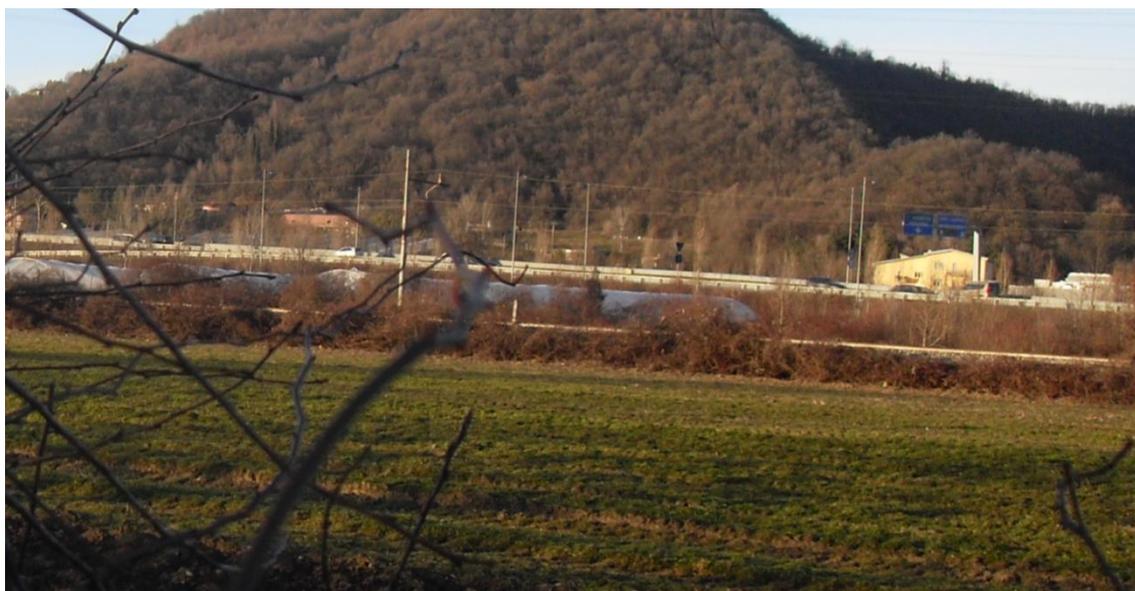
Vista delle aree di cantiere da via F.Filzi (sul lato sud della linea ferroviaria)
